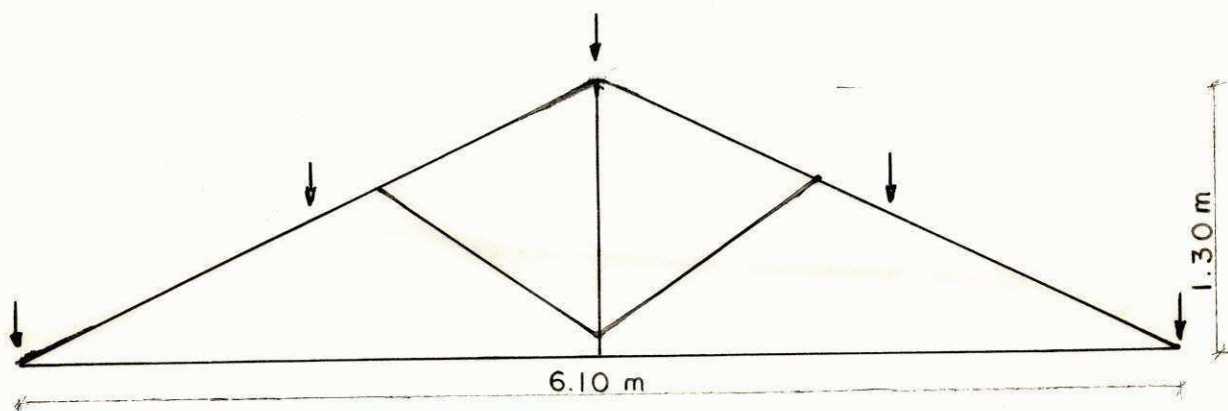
ESTRUTURA TRELIÇADA - CAMPAL ESC.: 1 : 40
